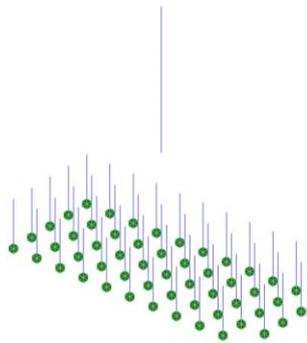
Конструктивная схема промежуточной опоры - свайного крепления
